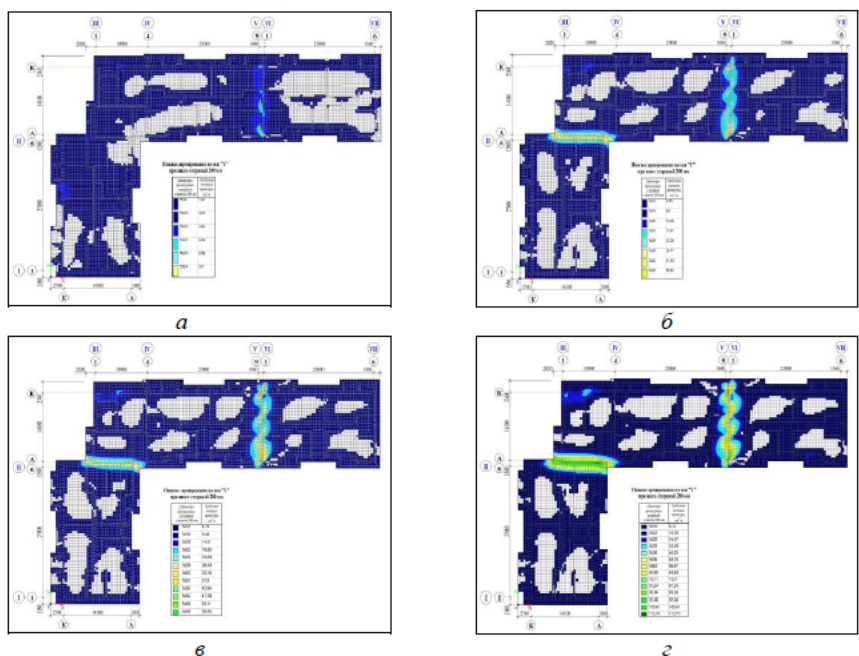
Сравнение фактического армирования с результатами расчетов армирования плиты на участках концентрации напряжений: а – нижнее армирование; б – верхнее армирование
